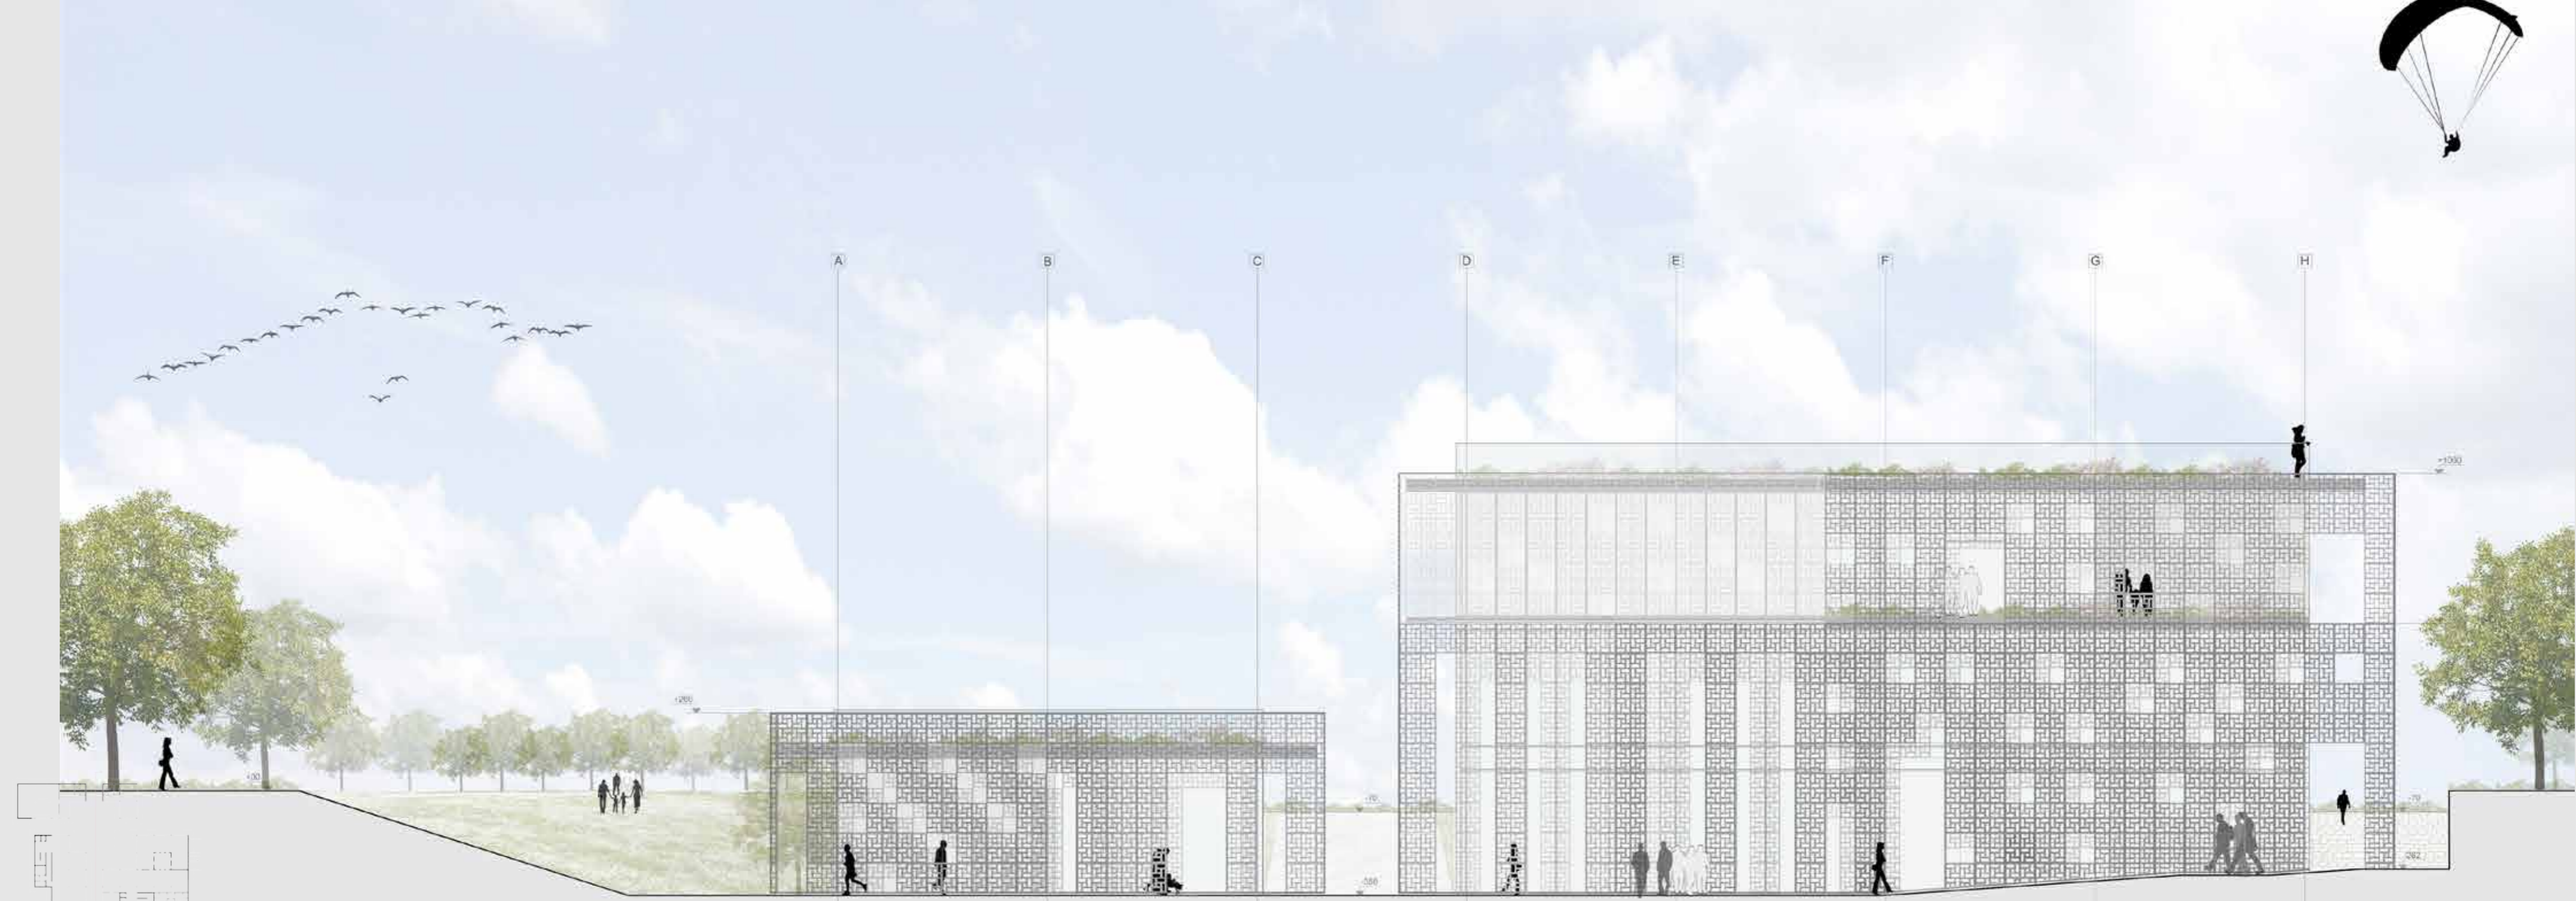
Prospetto Ovest interno alla corte - Scala: 1:200
